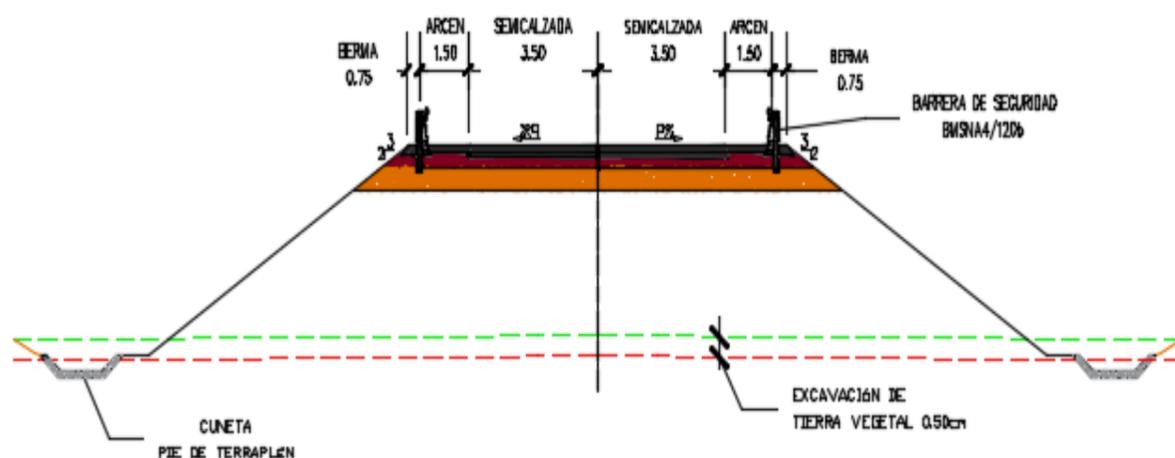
Detalle sección transversal. Fuente: Elaboración propia
